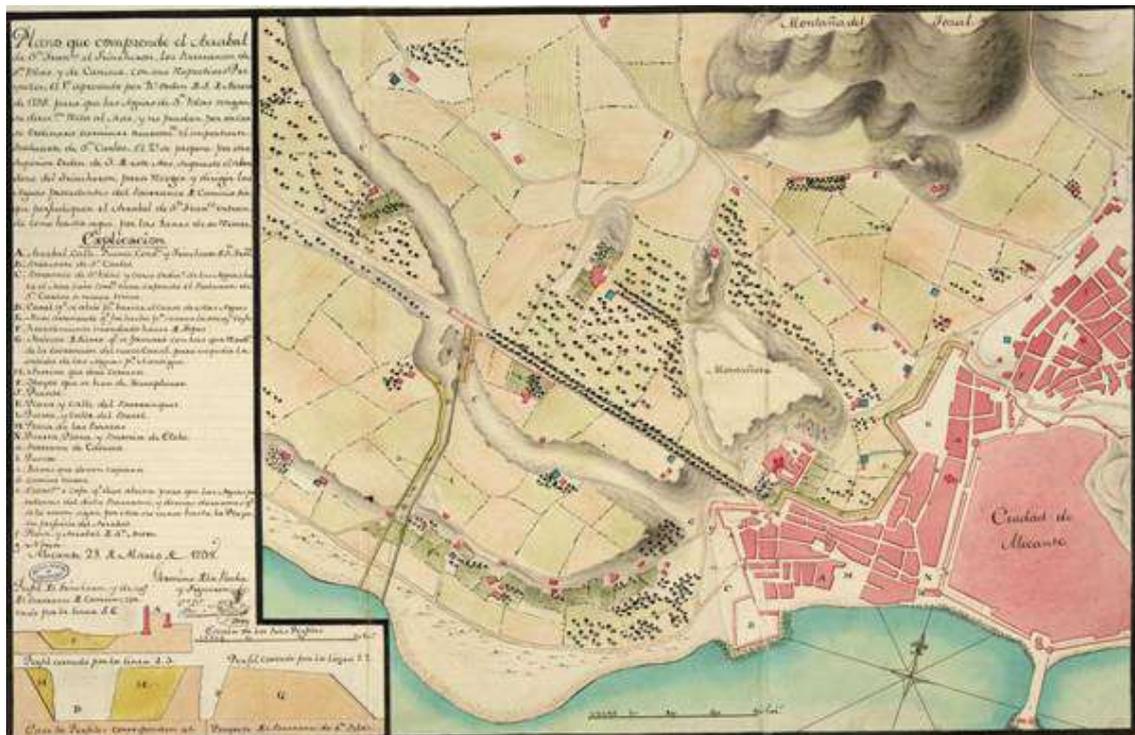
Proyecto de desvío del cauce del barranco de San Blas, 1772
